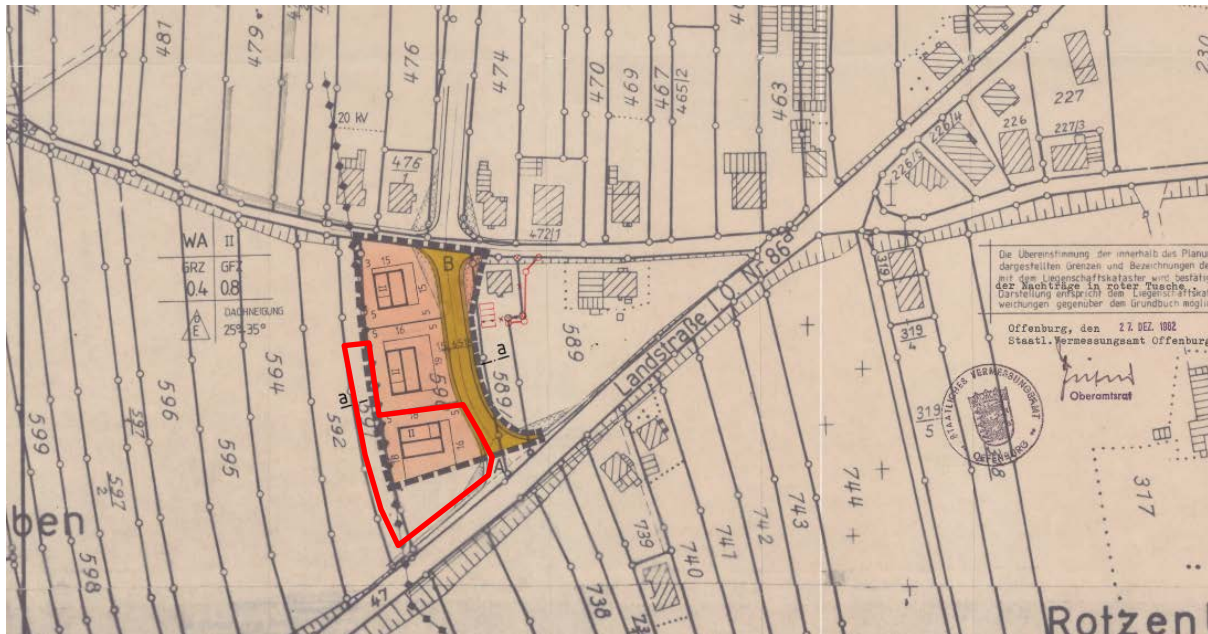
Ausschnitt des Bebauungsplanes "Westtangente Süd" aus dem Jahre 1982; Quelle: Ingenieurbüro Zimmer Lauf, eigene Darstellung
